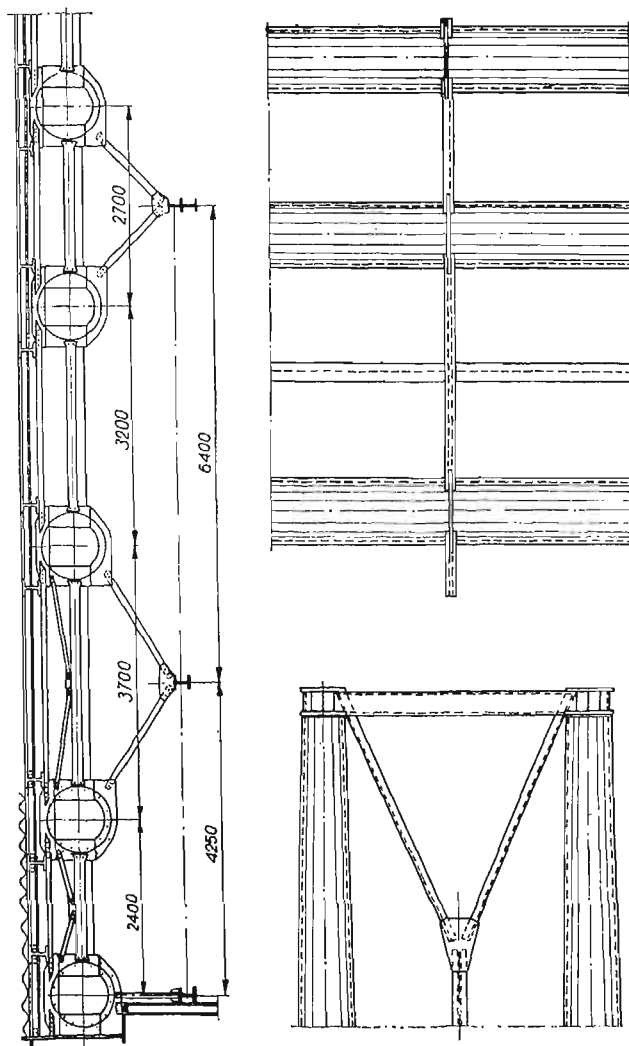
Przekrój elementu łukowego z rur blaszanych, łączonych na śruby.
